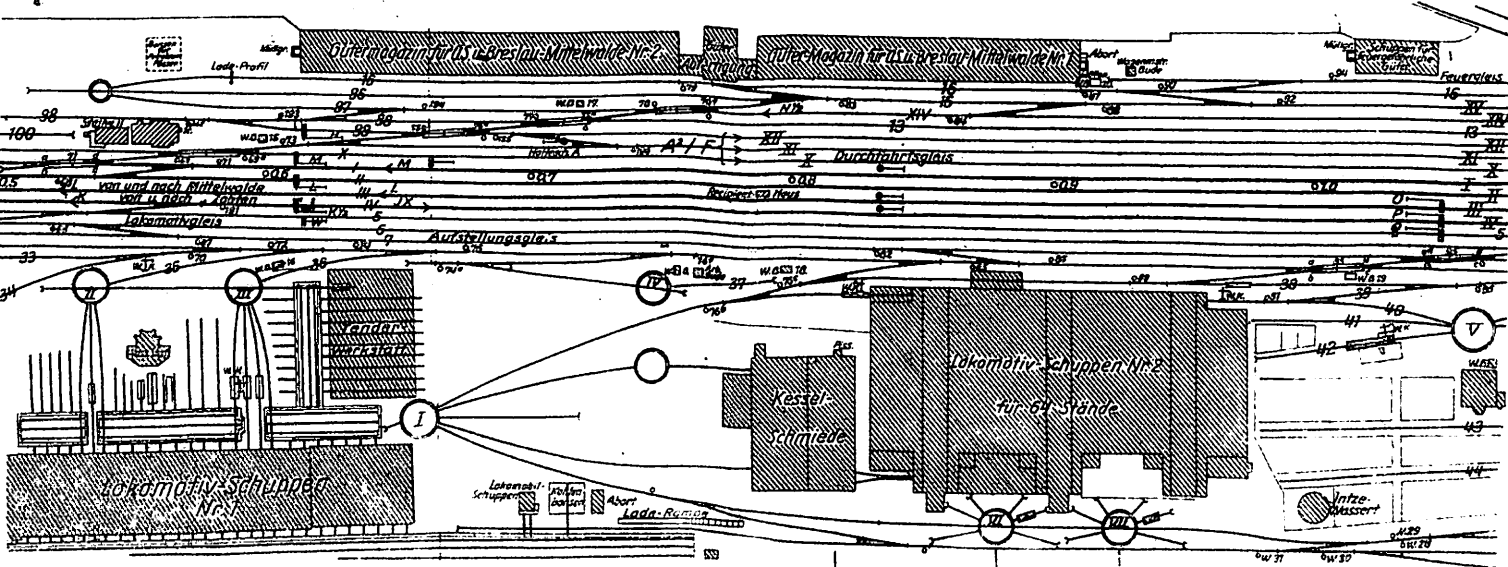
Lageplan des Bahnbetriebswerkes Breslau Hbf. nach dem Zustande vom Jahre 1902.
